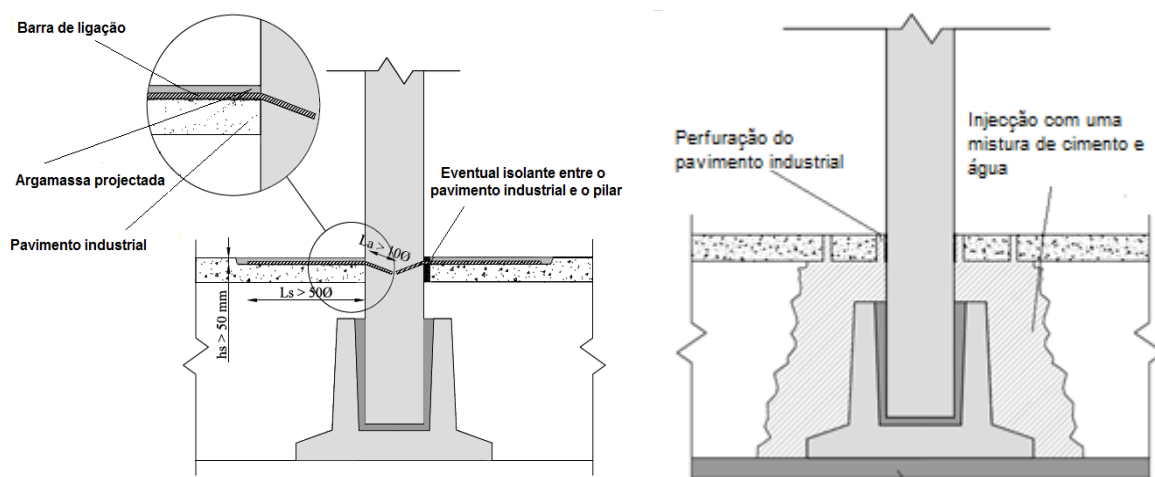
Exemplos de intervenções na ligação entre o pilar e fundação [1]
